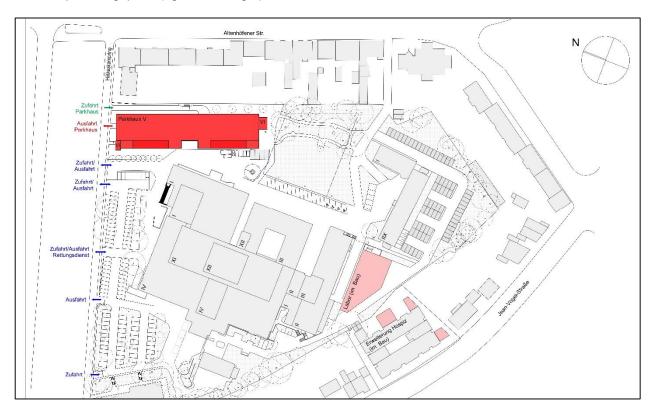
Lage des geplanten Parkhauses (Quelle: Krampe Schmidt Architekten, 2021) [5]
